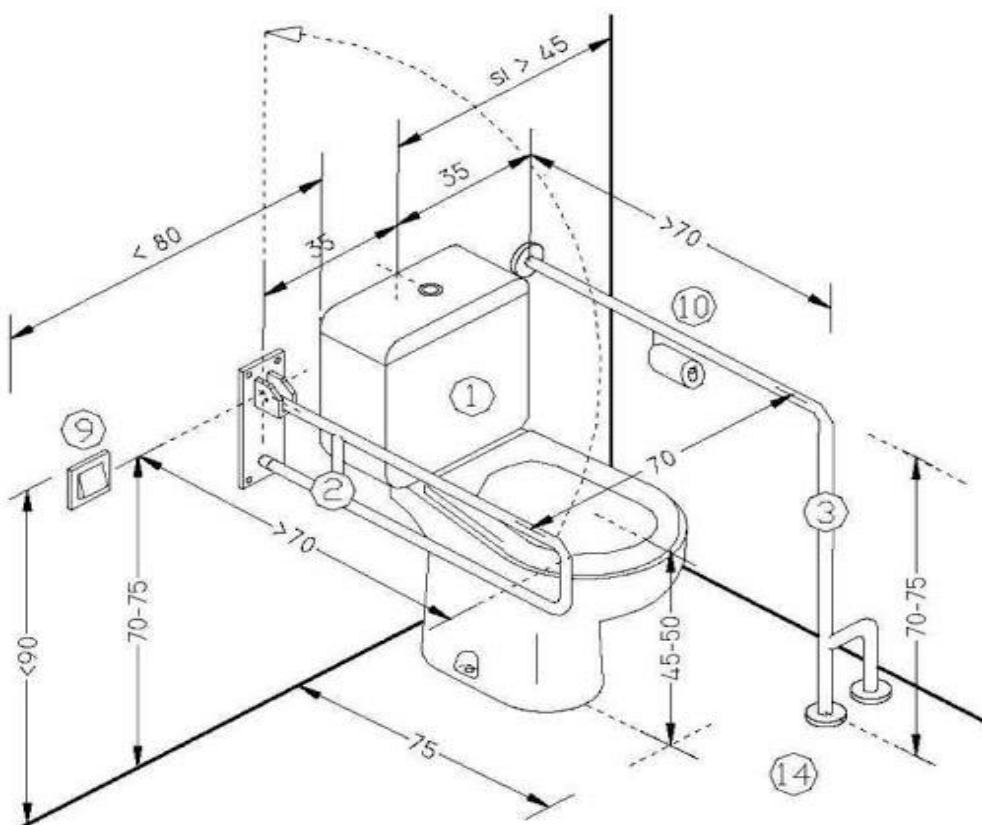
Изометрия туалета для инвалидов. Установочные размеры приборов.
